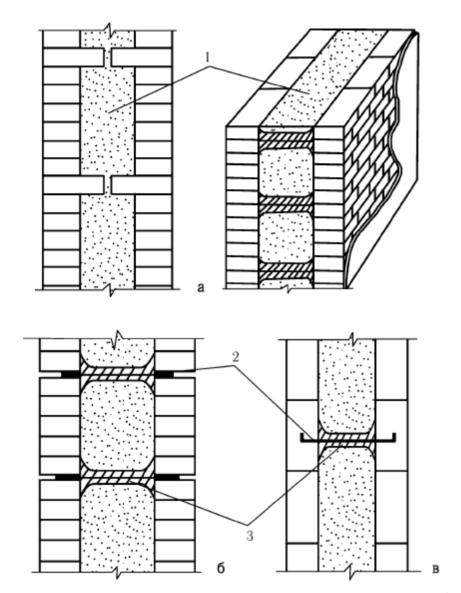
Выполнение кладки с горизонтальными диафрагмами: а – из кирпича; б, в – из раствора, усиленного стальной арматурой; 1 – засыпка (легкий бетон); 2 – арматурный пруток; 3 – раствор
